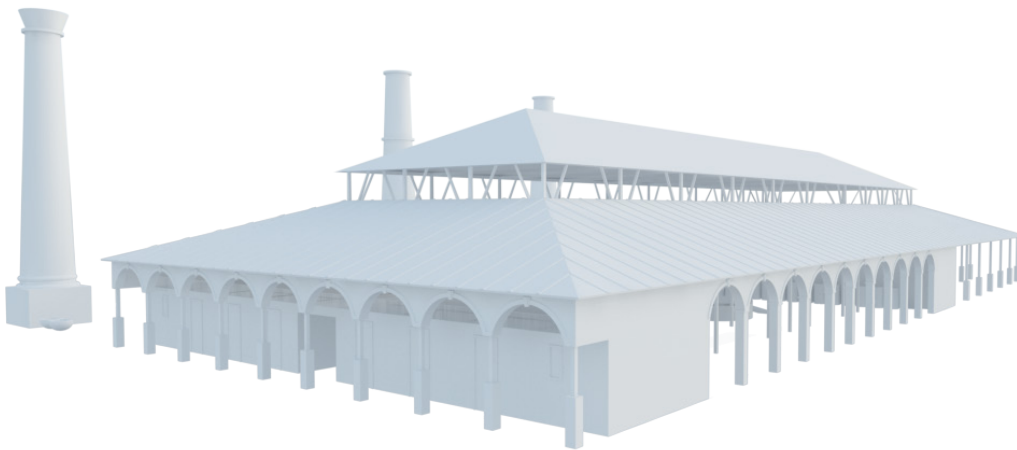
Modelo 3D de la Casa de calderas. Fuente: Elaboración propia
